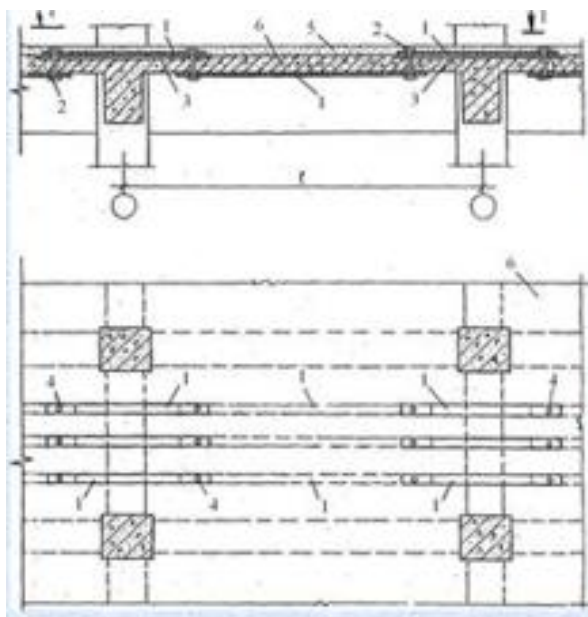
Усиление монолитных плит перекрытия с помощью металлических полос, закрепленных с двух сторон: 1 - стальная полоса – 100х6; 2 – анкерный болт М12; 3 – клей; 4 – отверстия под болты; 5 – цементно-песчаный раствор; 6 – усиливаемая плита
